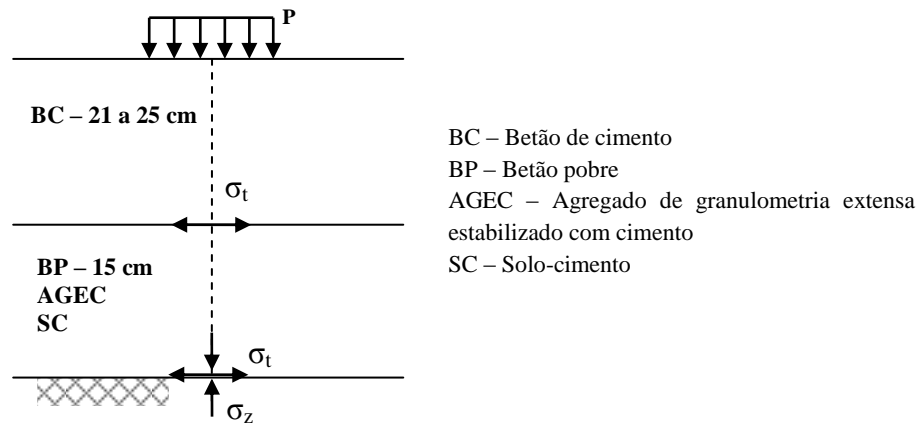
Constituição e comportamento de um pavimento rígido (adaptado de Branco *et al*, 2005)
